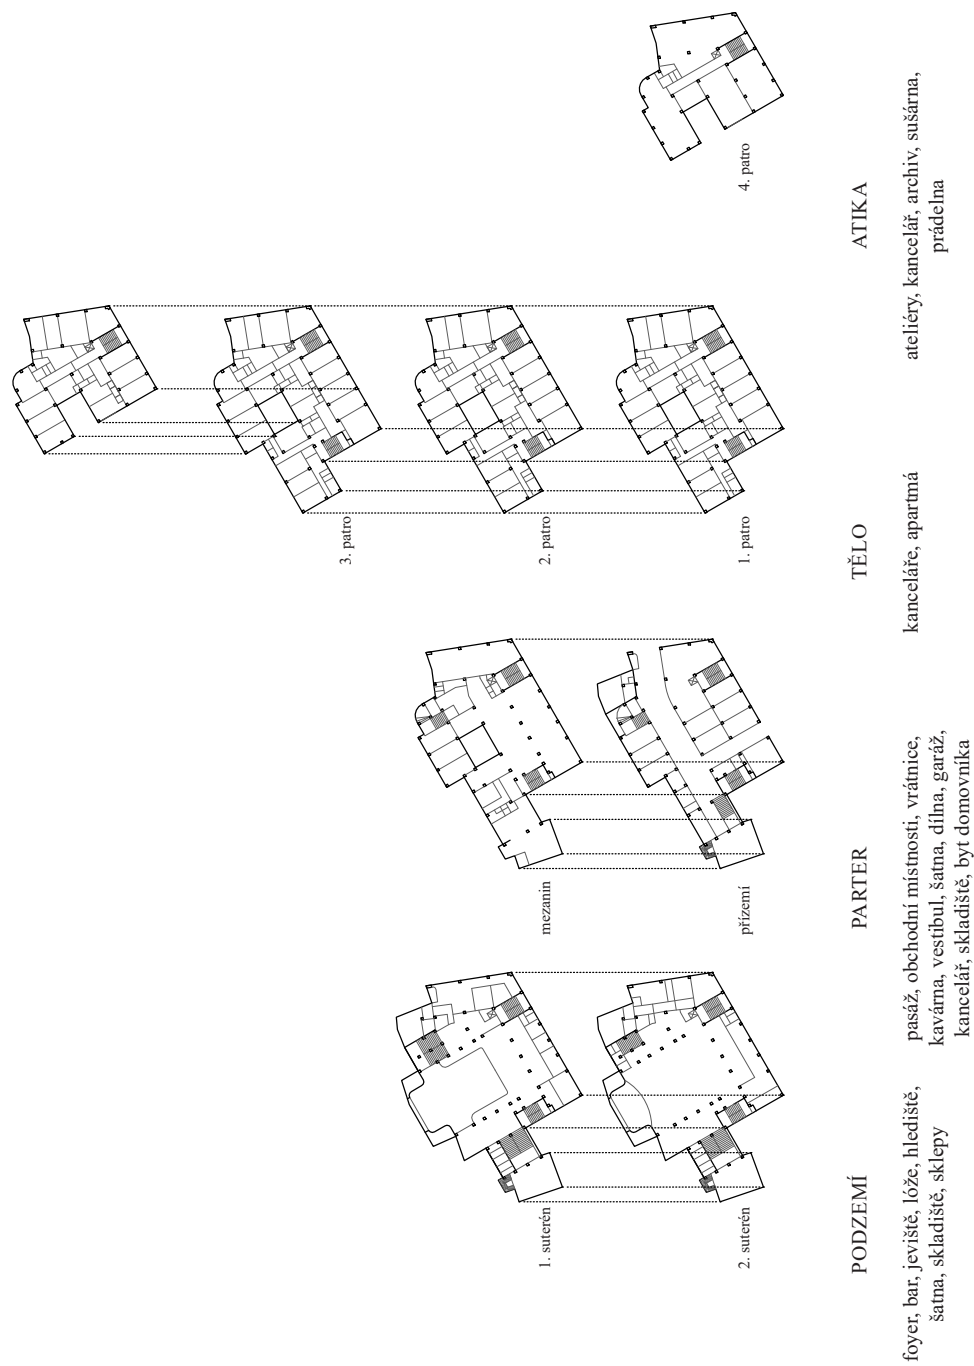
Rozložené plány paláce Sušický 1:1500.
